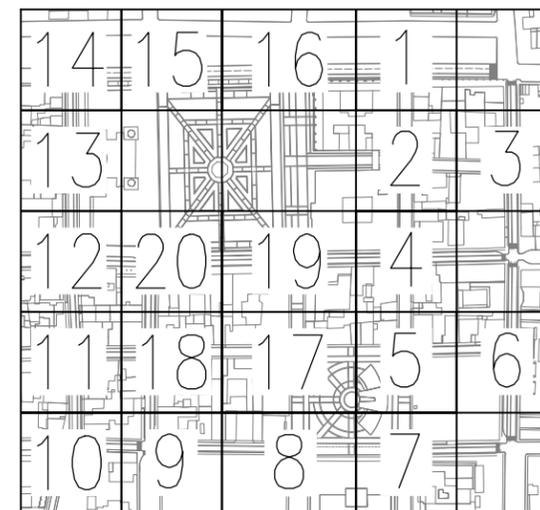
Secciones abordadas para proyecto arquitectónico. Fuente: Elaboración propia.
